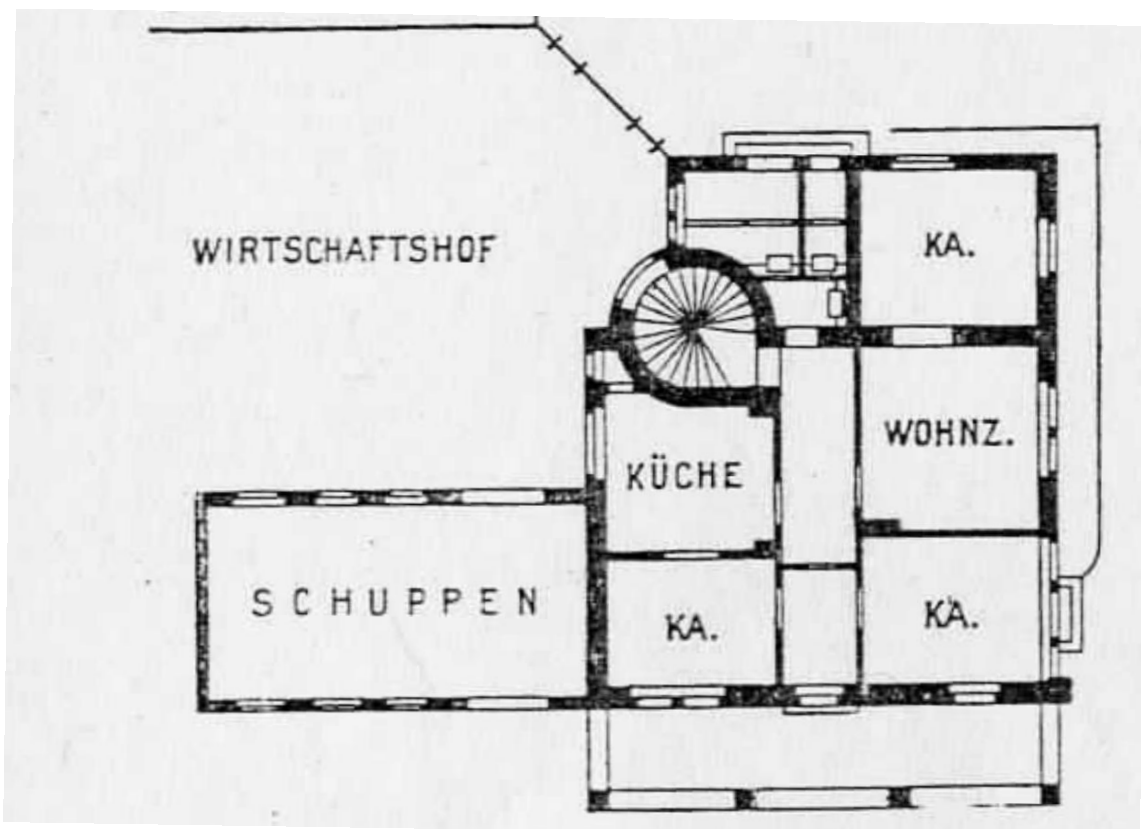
Grundriss EG, Verwalterhaus
